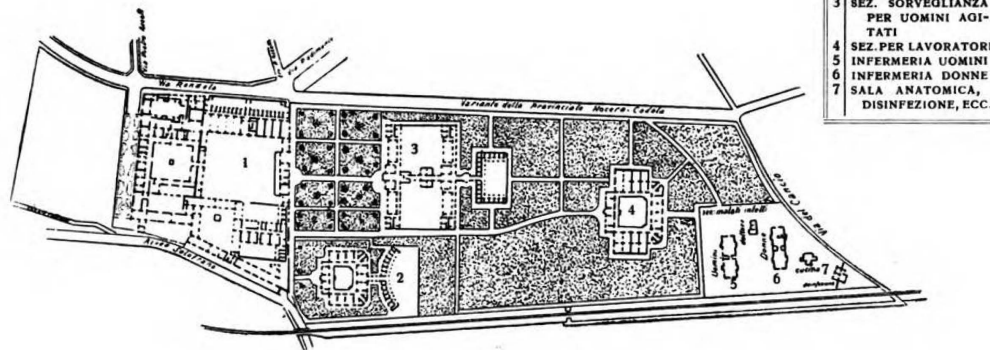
PROGETTO FERRAIOLI 1908. - Planimetria.
